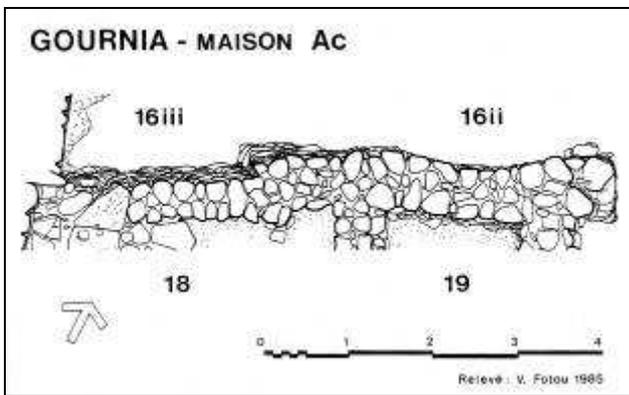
Gournia. Casa Ac. Pianta di un muro di sostruzione (FOTOU 1990)
